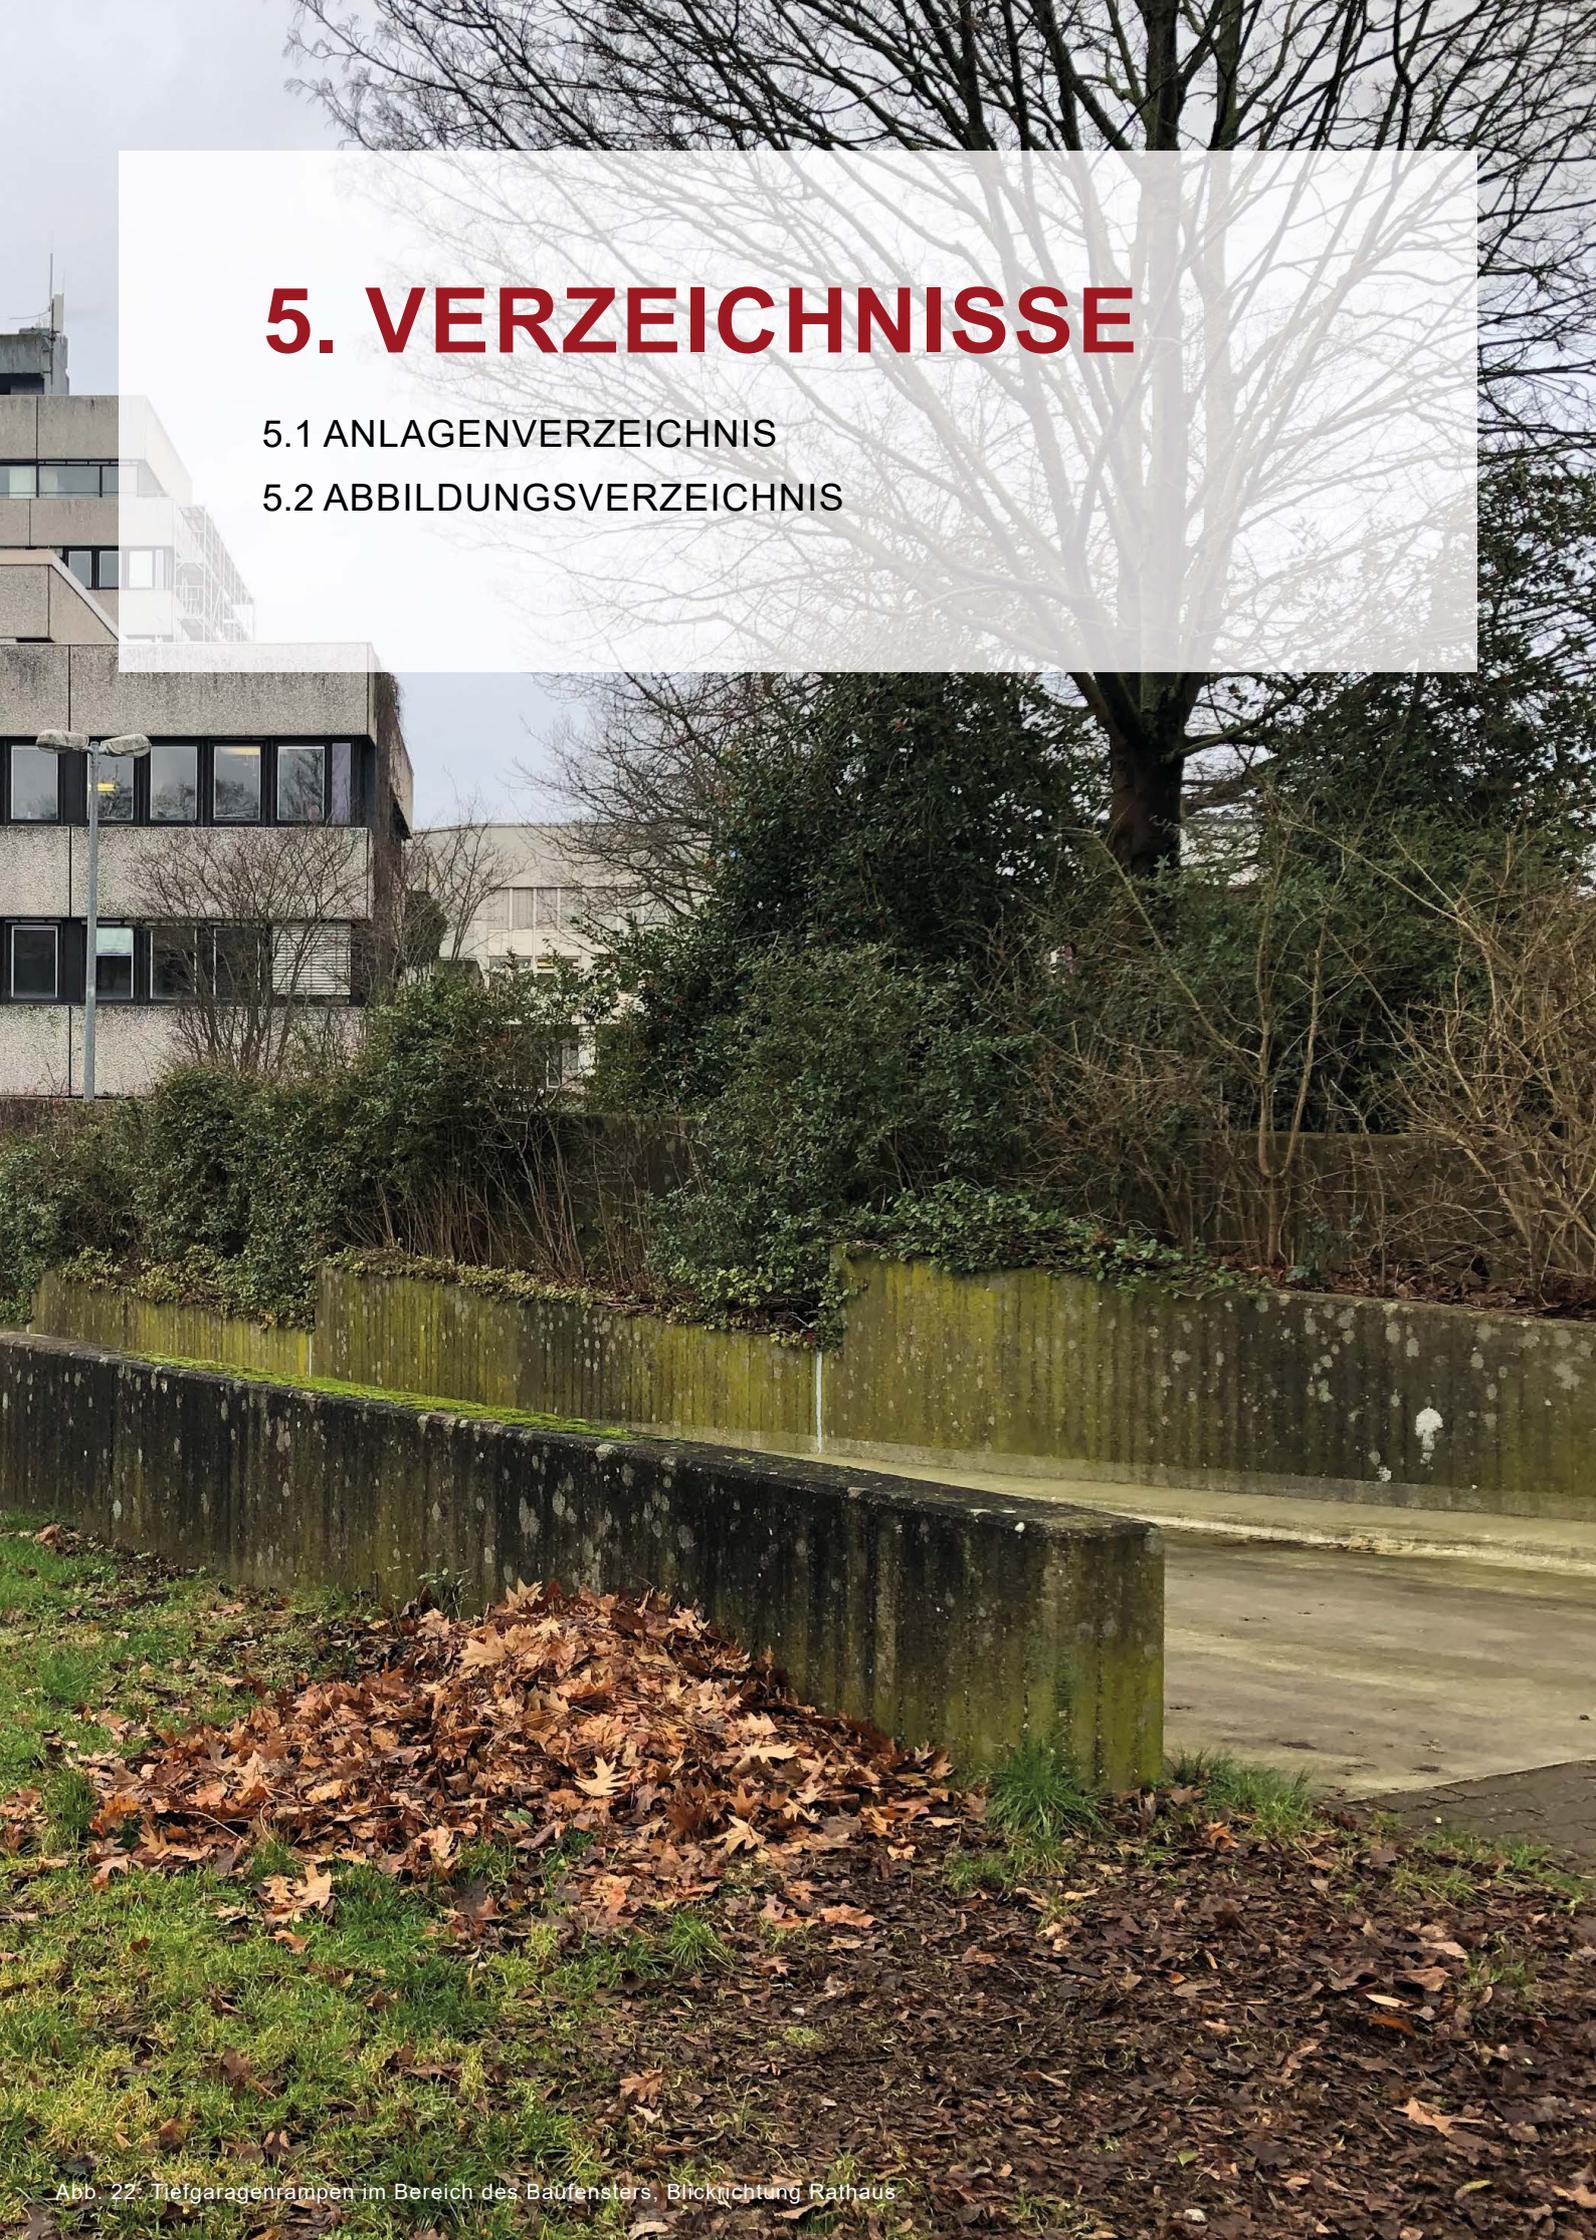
Tiefgaragenrampen im Bereich des Baufensters, Blickrichtung Rathaus
